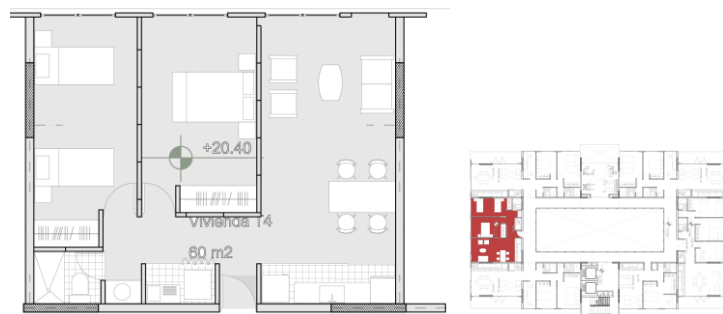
Planta Tipológica 4 (Jordan Baldassari, 2018)
